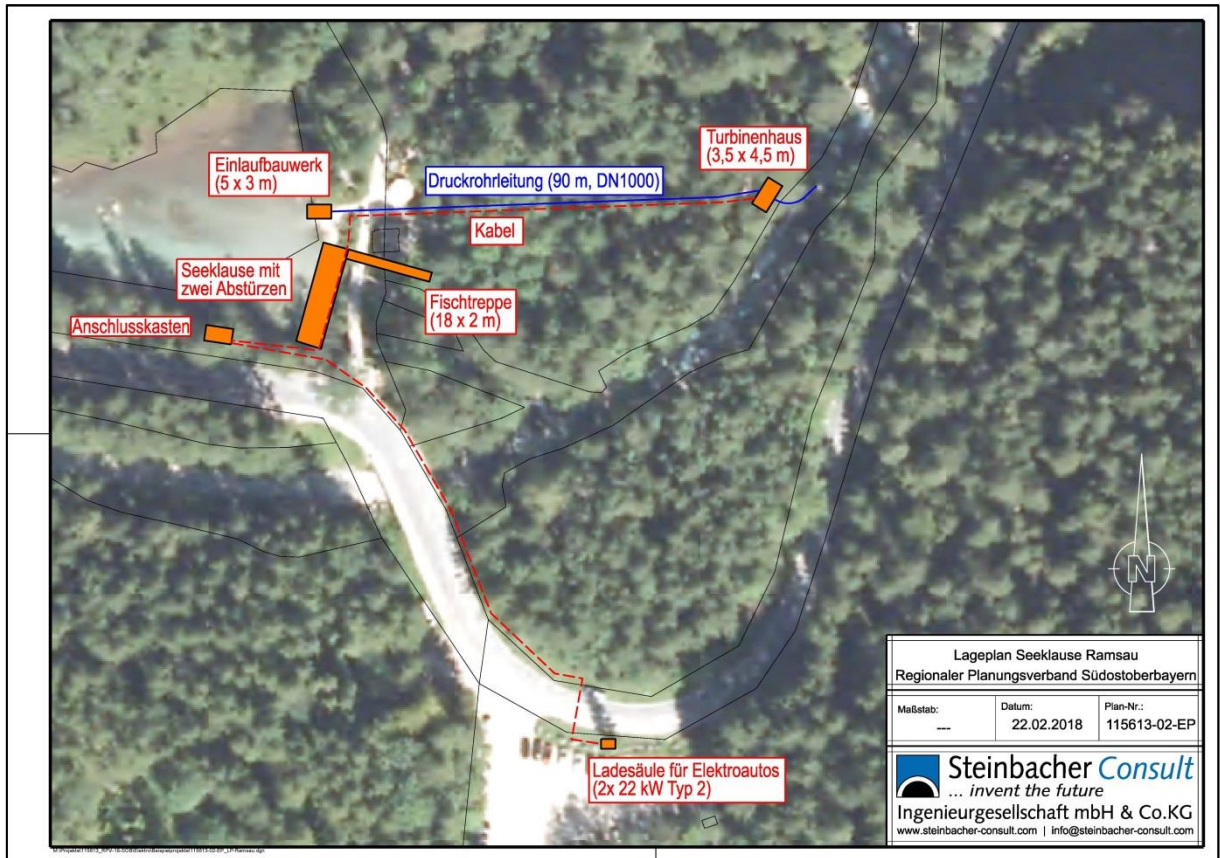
Lageplan der geplanten Wasserkraftanlage an der Seeklause
